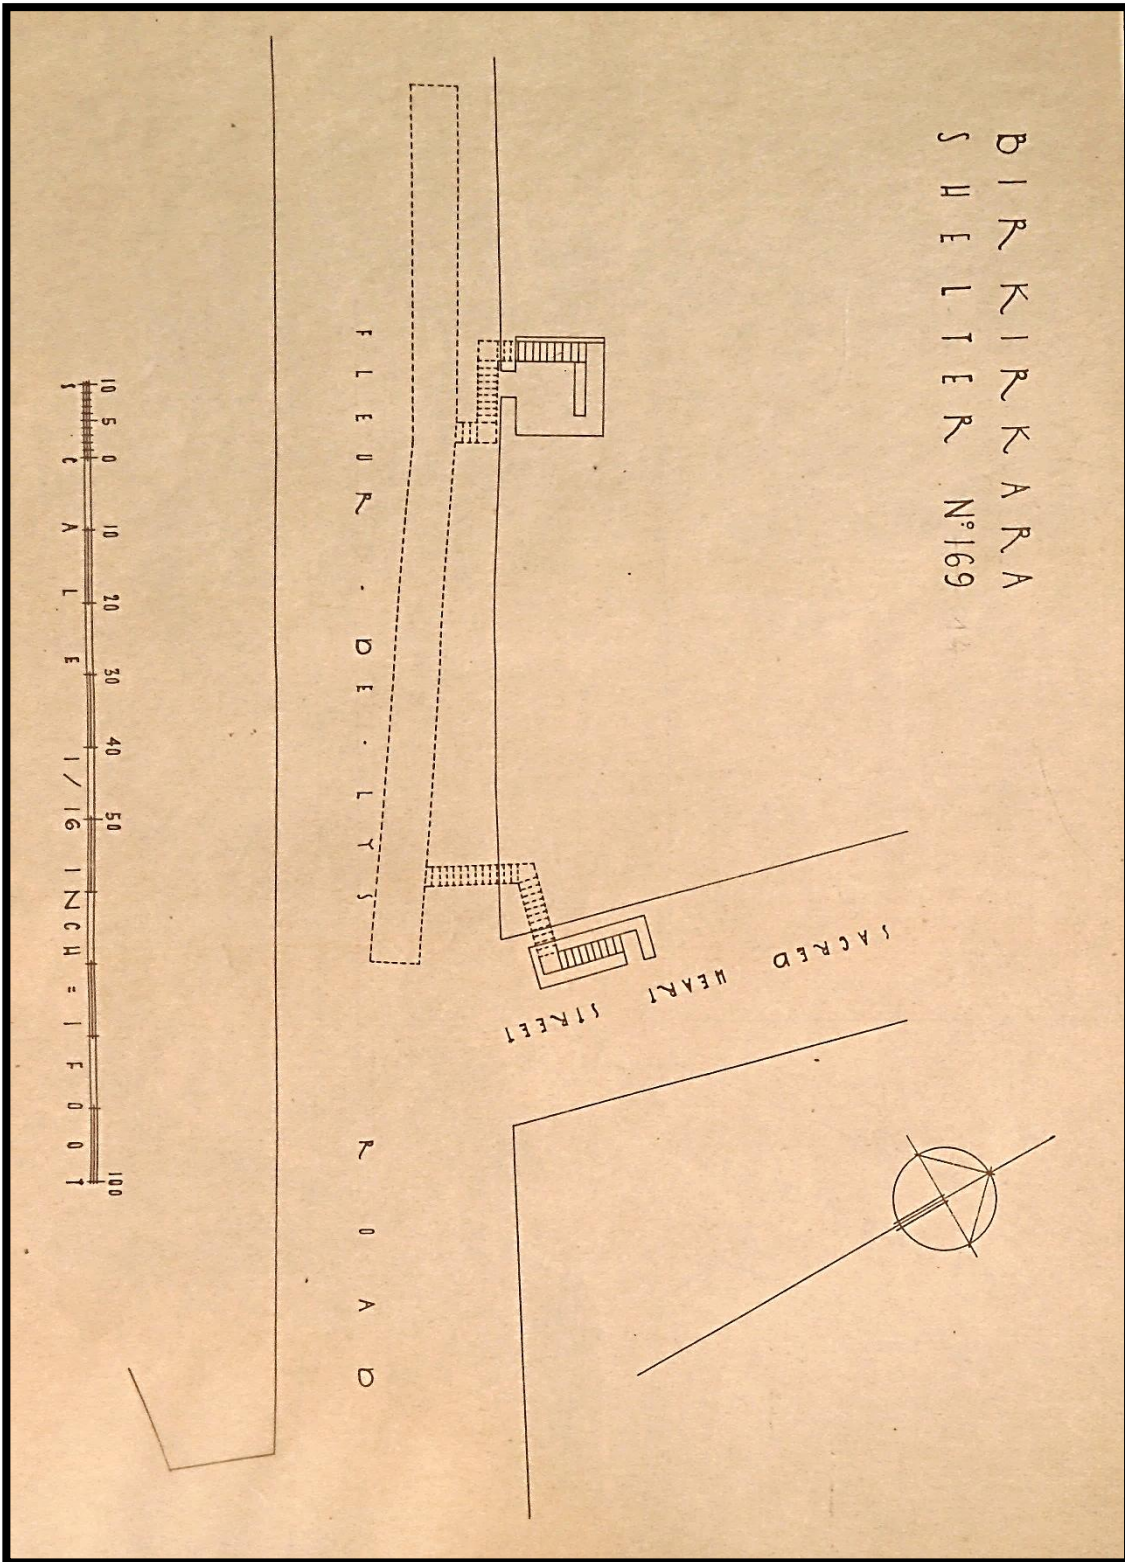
Planta do Abrigo nº169 (14) "Fleur-de-Lis Road – Sacred Heart Street."
